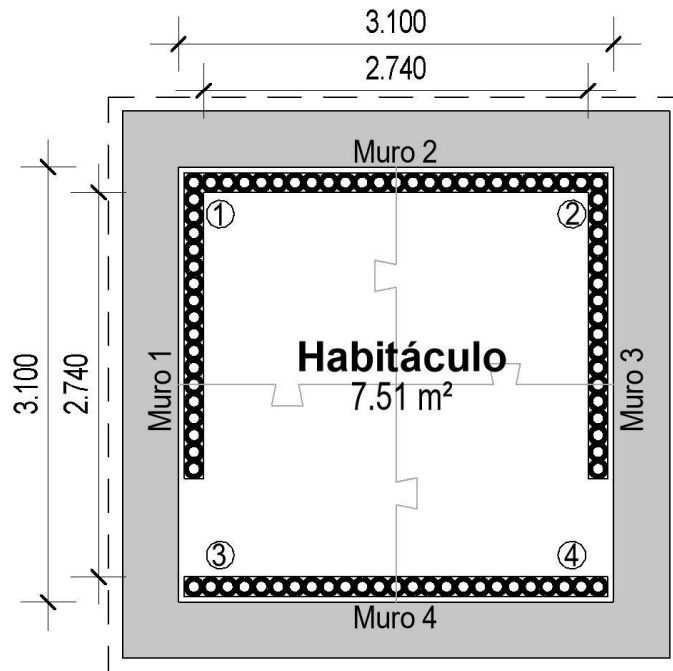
Planta baja del módulo emergencial. Fuente: Desarrollado por el autor
